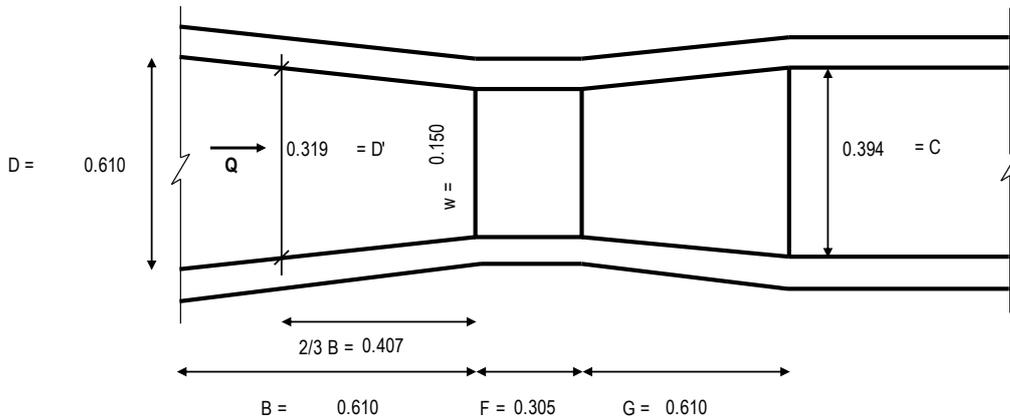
Esquema de Canaleta Parshall - Planta (Elaboración: Propia)
